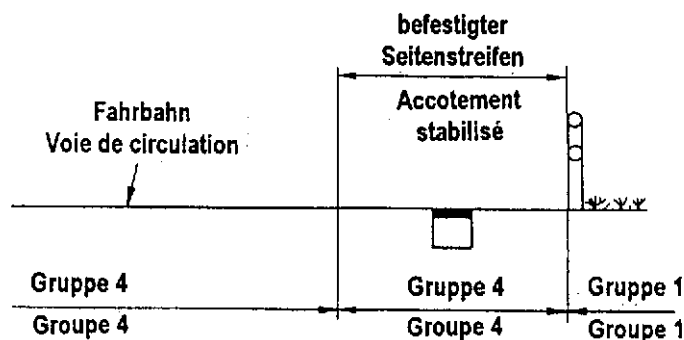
Typisches Detail eines Seitenstreifens mit Darstellung einiger Gruppen von Einbaustellen
